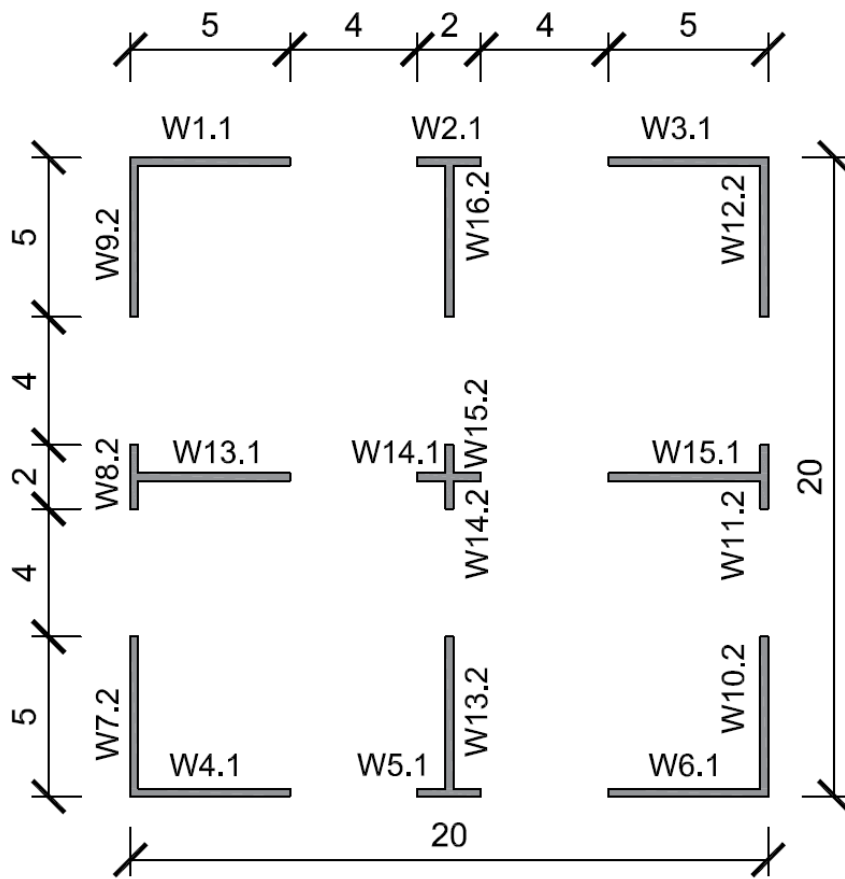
Grundriss des Beispielgebäudes
